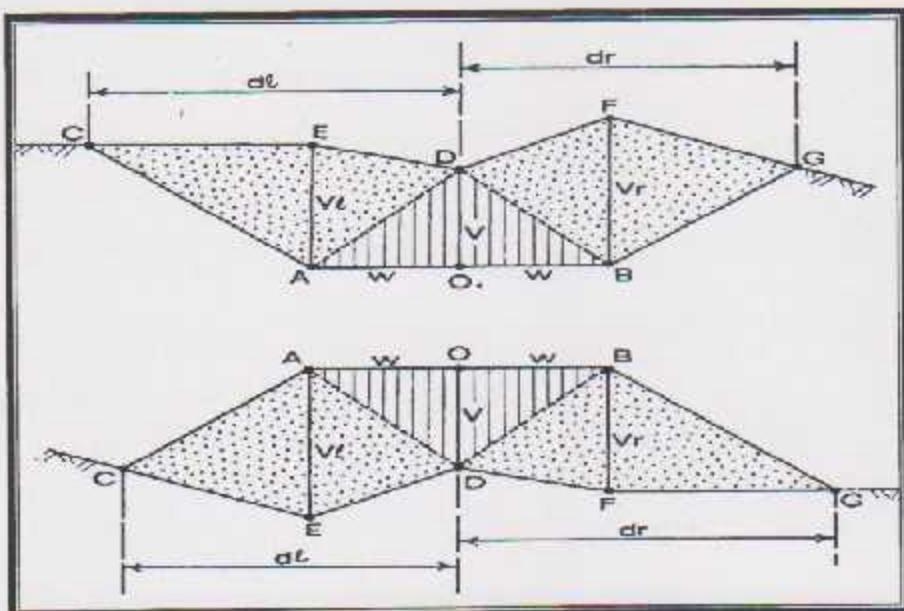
مقطع عرضي من ثلاث نقاط.
